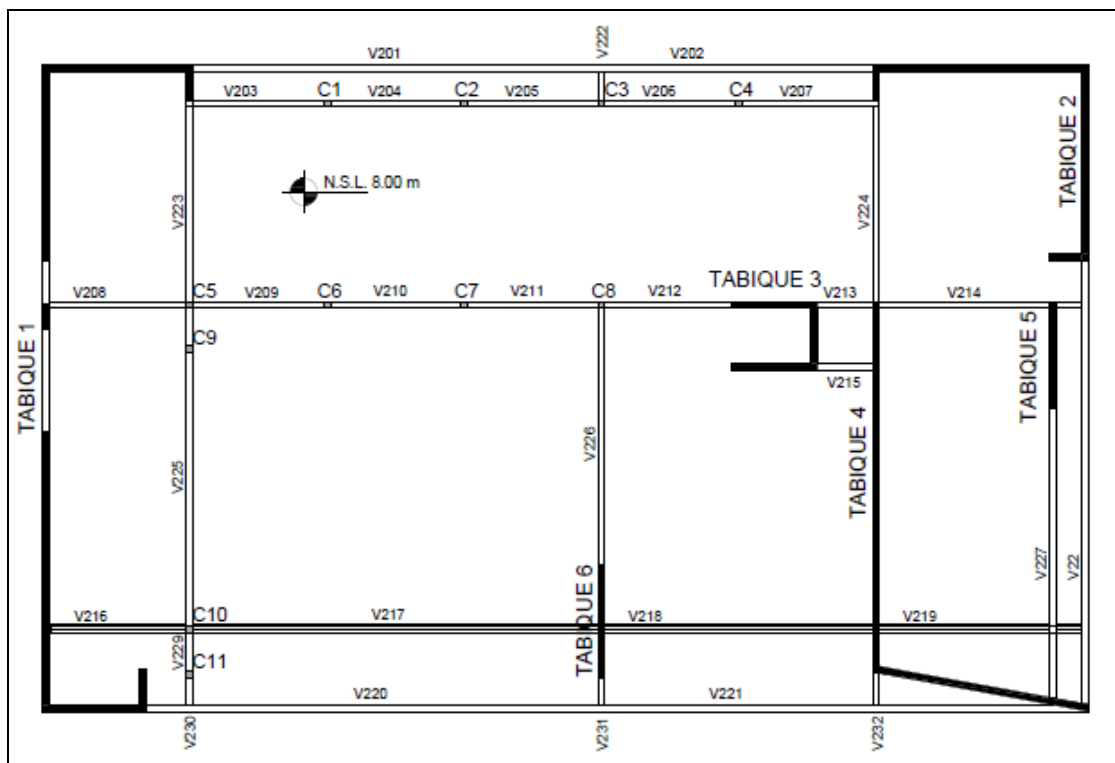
CORTE SECCIÓN A +8,0M
